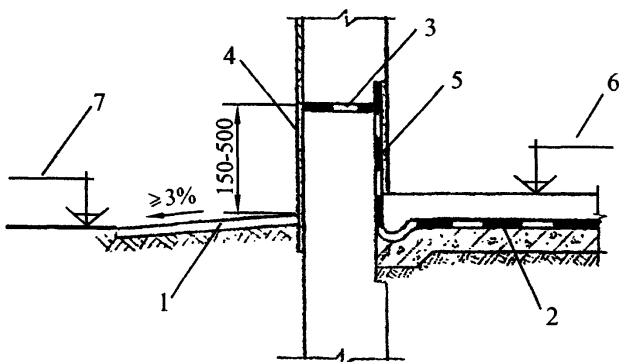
Устройство прокладок в стенах зданий без подвалов с подрезкой стены
